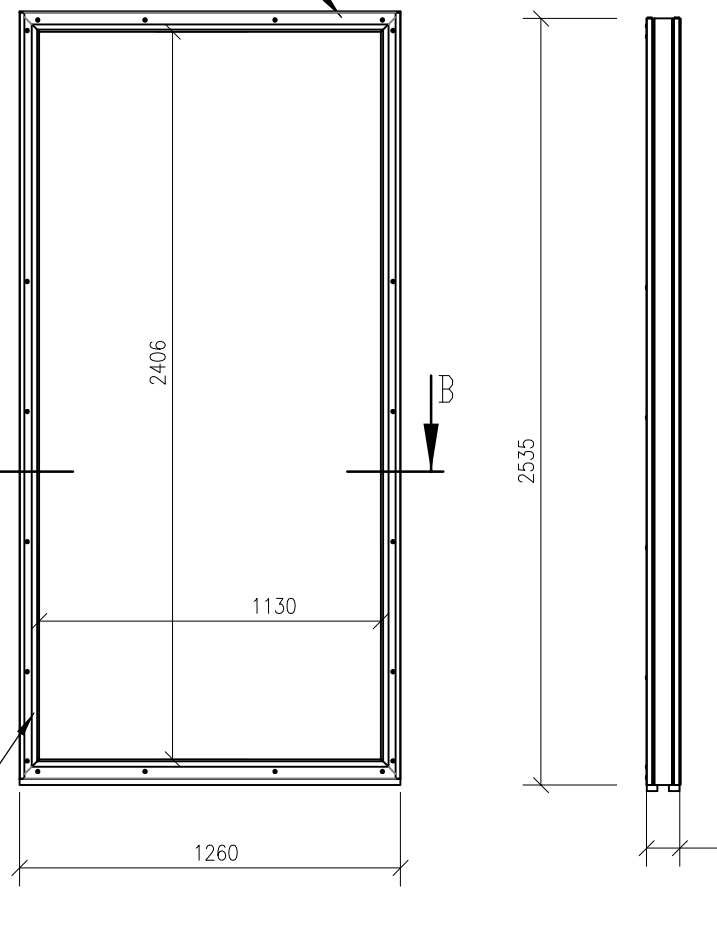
DETAIL - OBSLUŽNÝ VÝCHOD, 1:10
